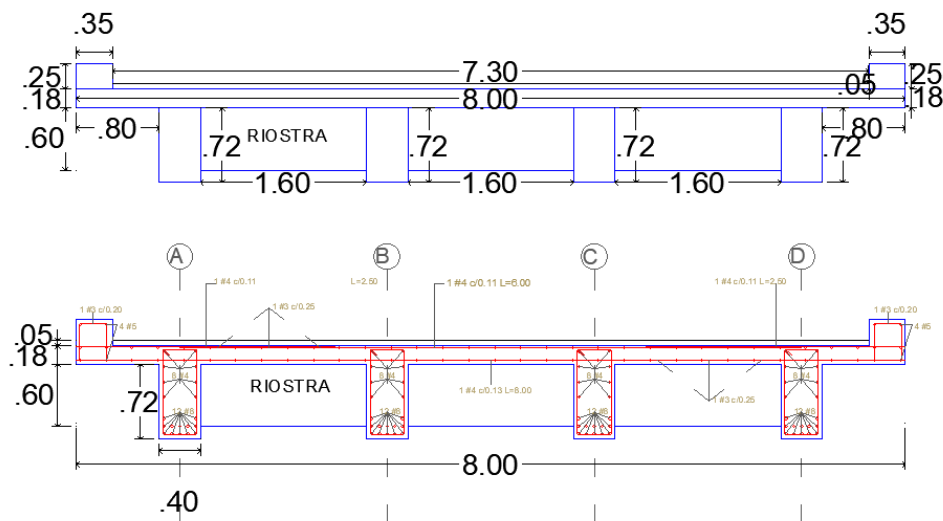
Sección transversal de la estructura de un puente de concreto reforzado de 12 metros (ver anexo 02 página 03)
